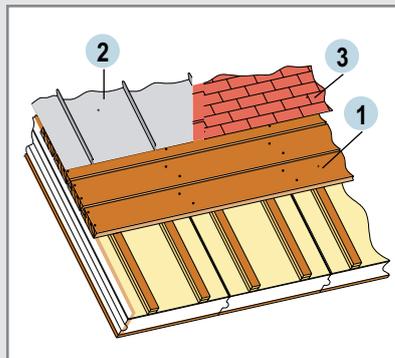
Couverture zinc, cuivre, bardeaux bitumés ou étancheité
